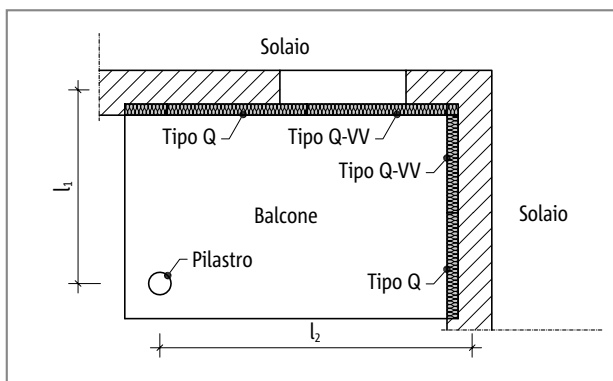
Schöck Isokorb® tipo Q, QP-VV, balcone con appoggio su due lati e pilastro
